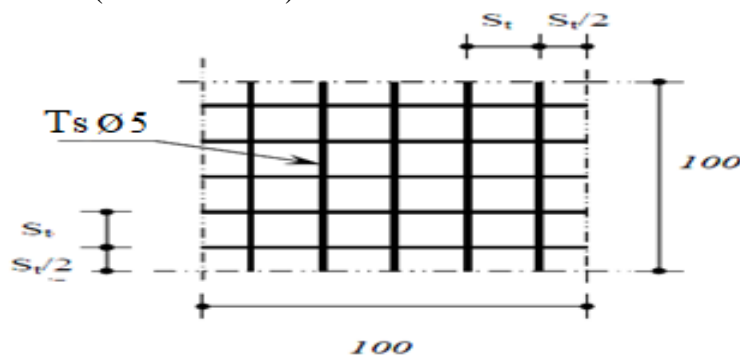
Treillis soudées de la dalle de compression
